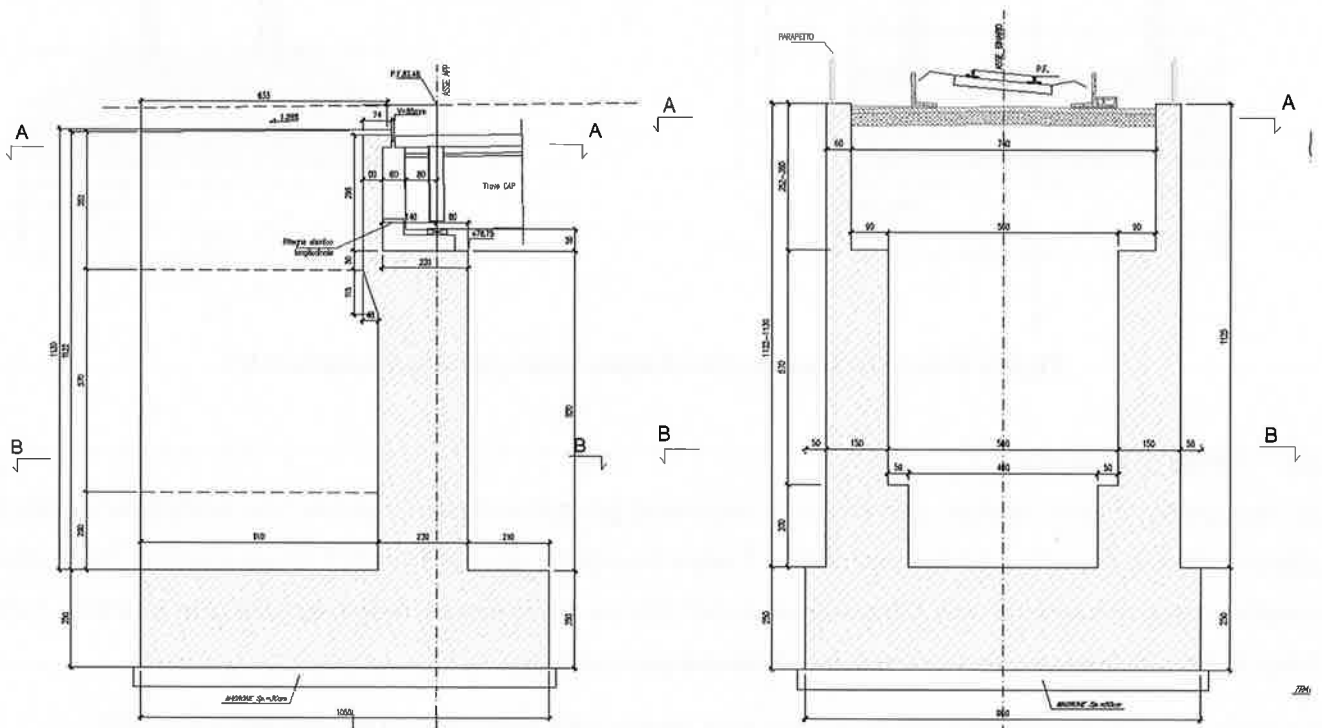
Sezione longitudinale e trasversale spalla A Bauladu VI01
